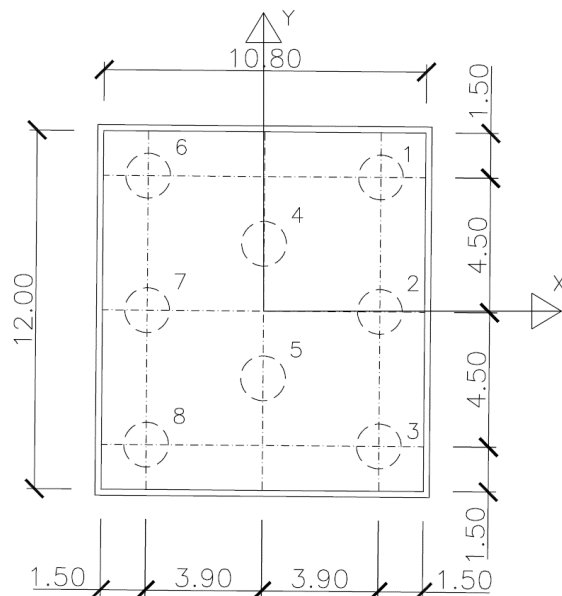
pianta pali – Pile 3÷9 a 8 pali
